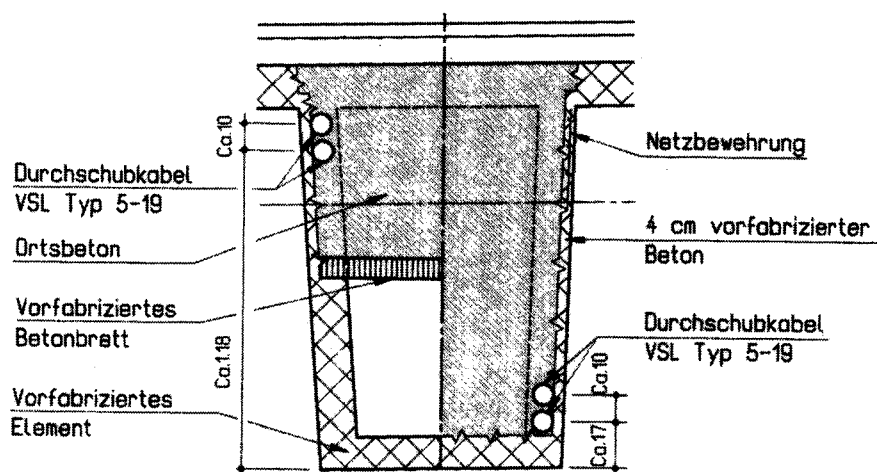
Coupe d'une poutre préfabriquée au droit d'une béguille et en travée
